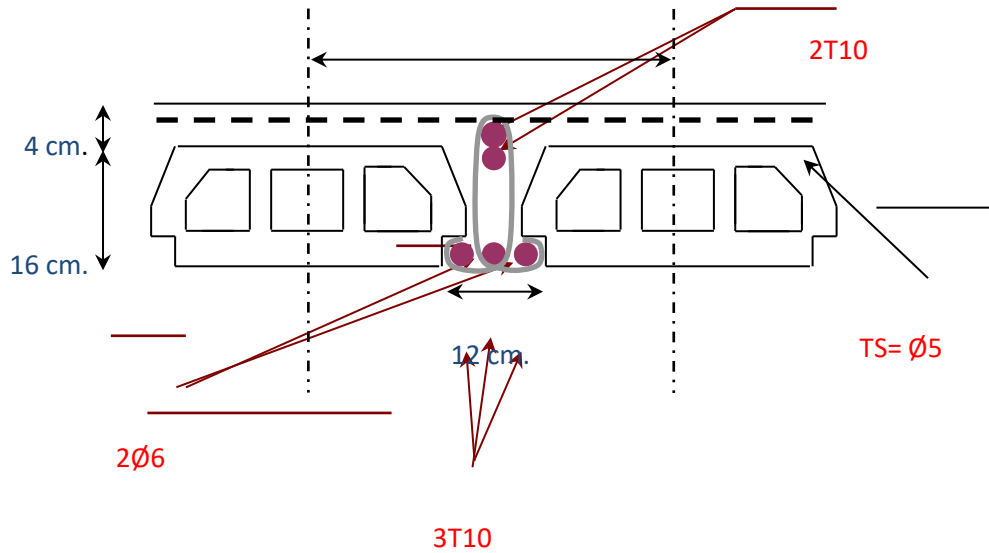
ferraillage de poutrelle au RDC et étage courant
